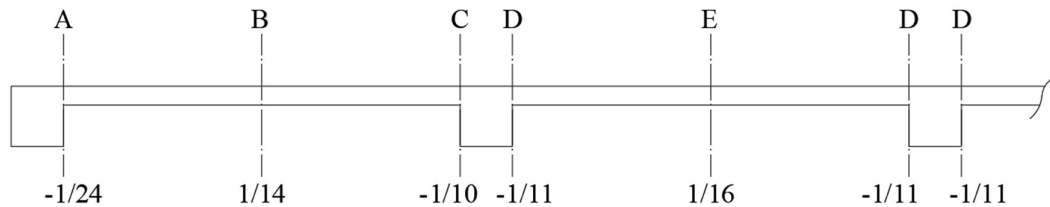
Tampak plat dan balok (Potongan melintang)
